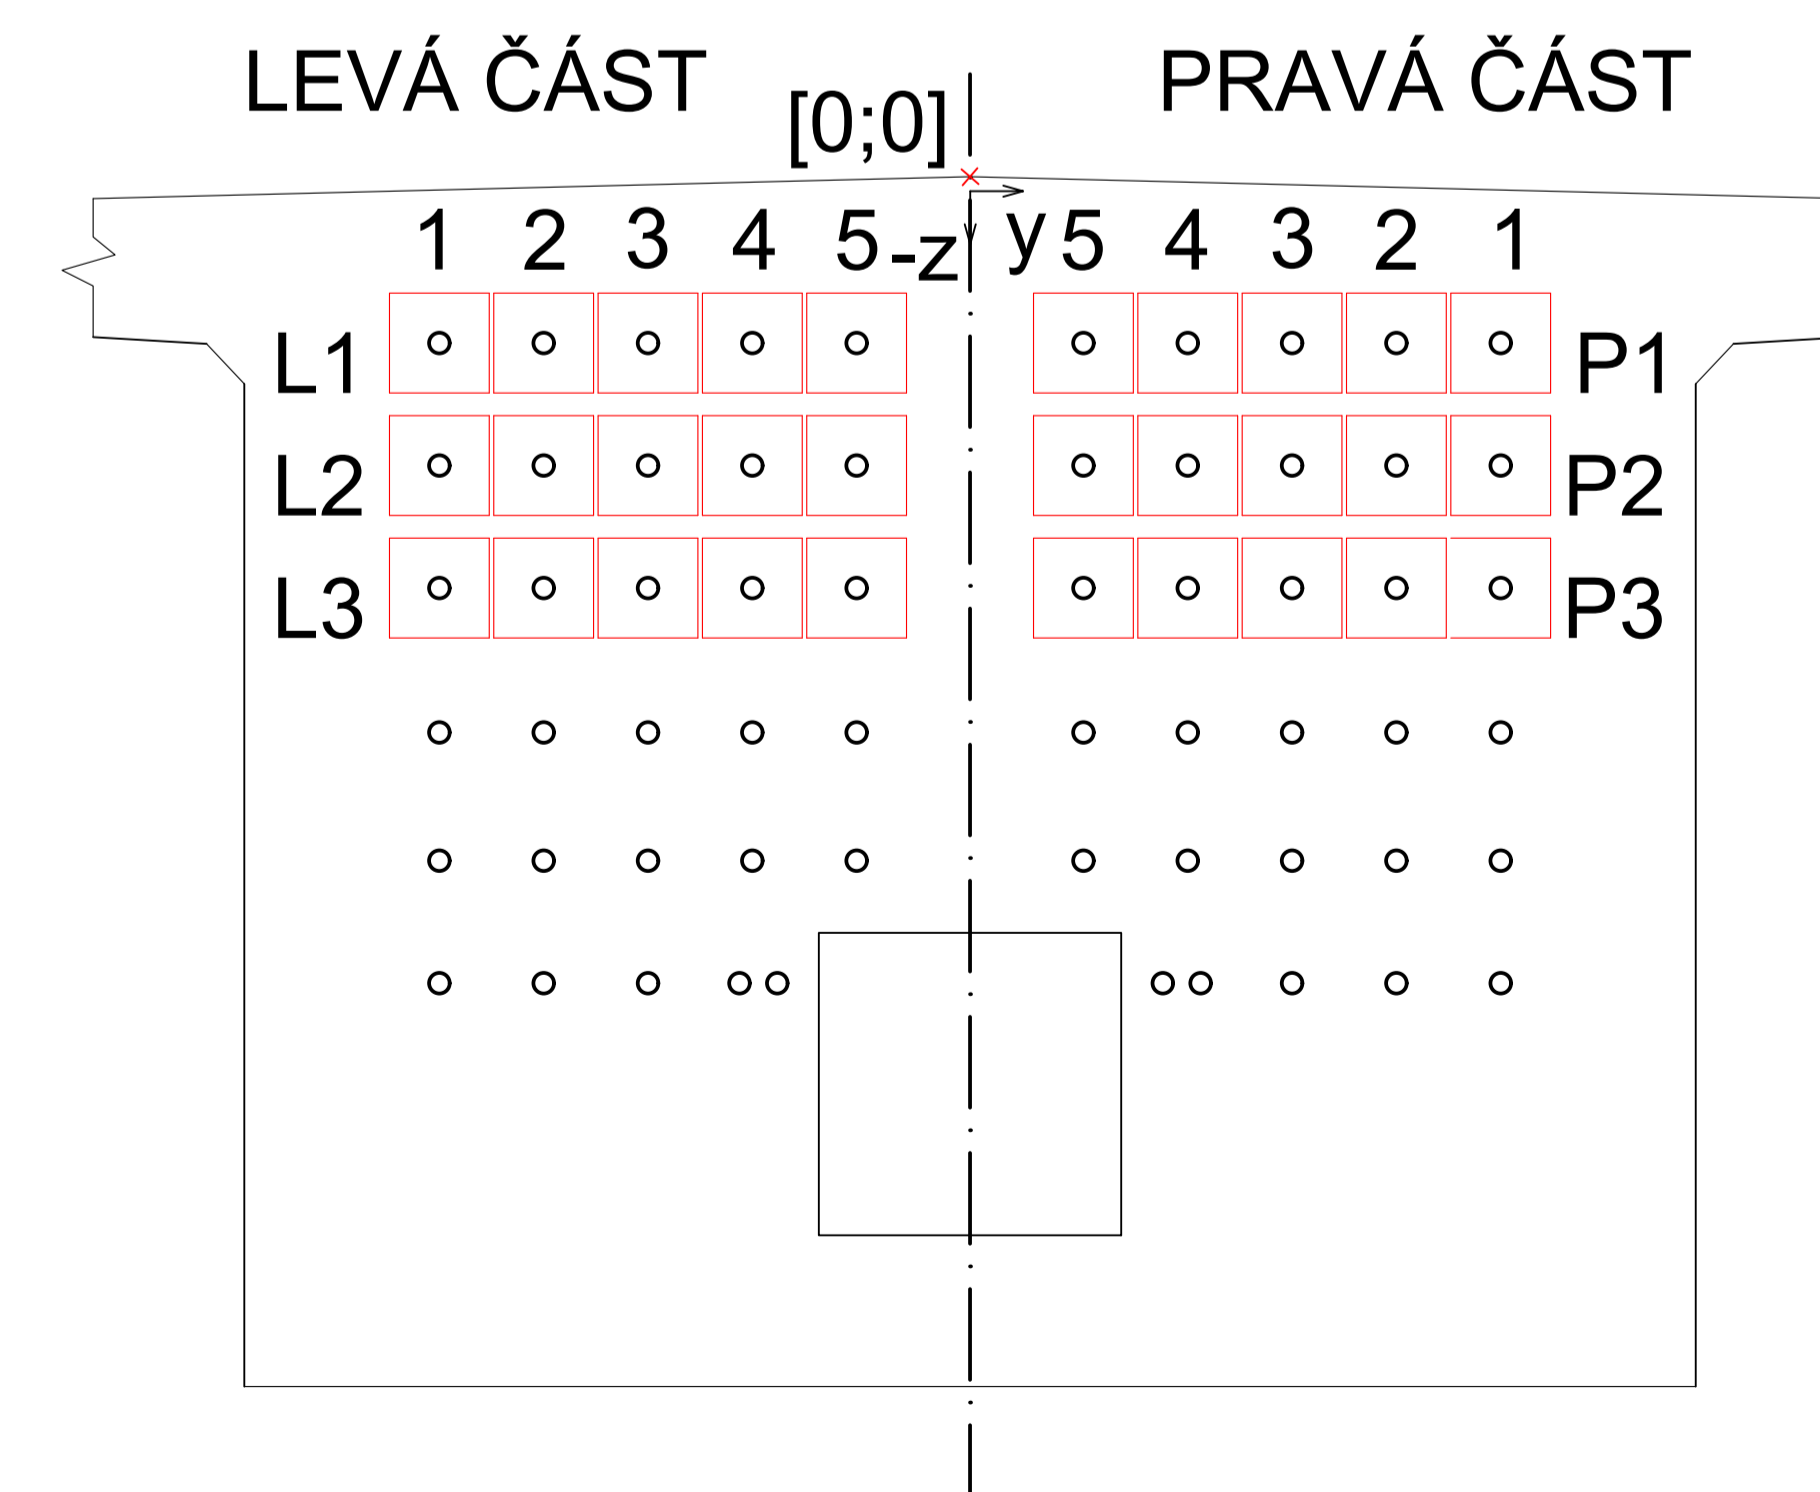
## DETAIL PŘÍČNÉHO ŘEZU B-B'
